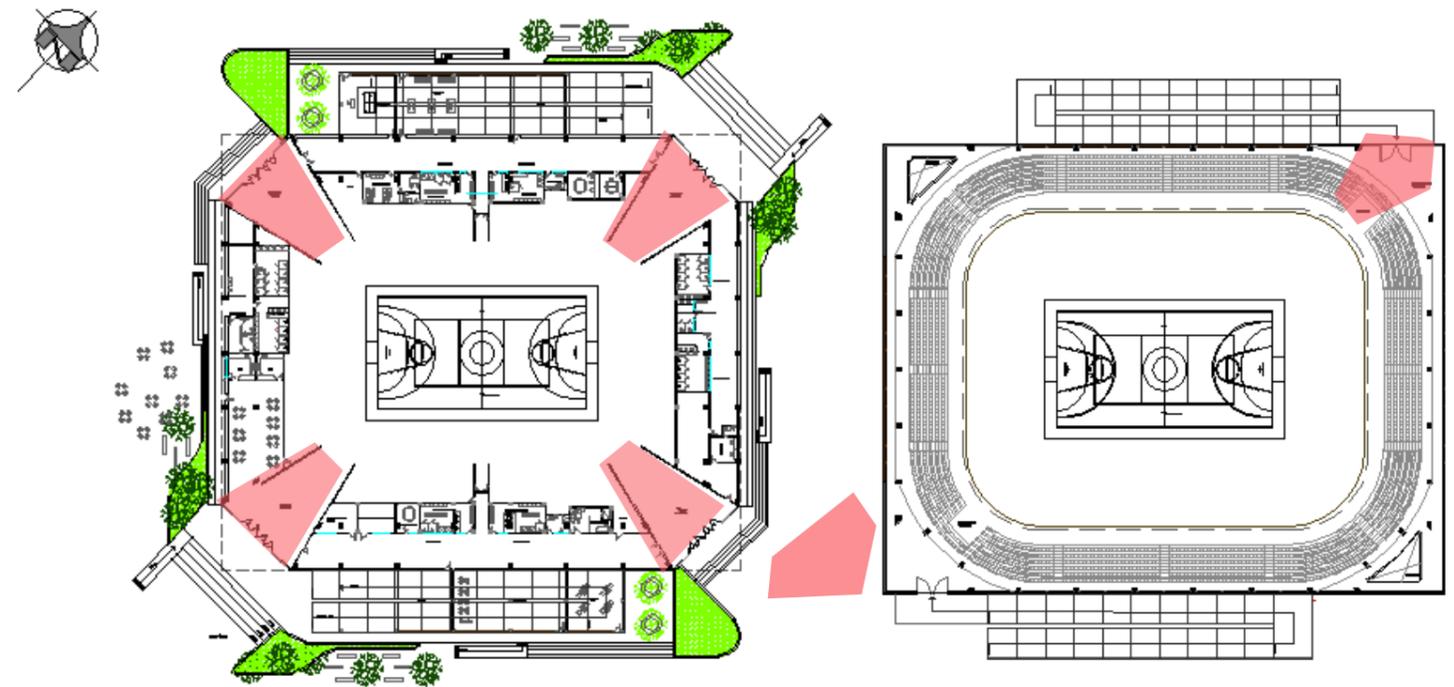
Graficación de salidas de emergencia en planta baja y alta.
